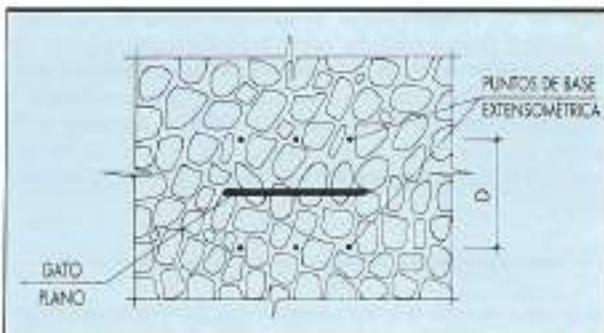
Esquema del ensayo de tensión in situ mediante gato plano.
